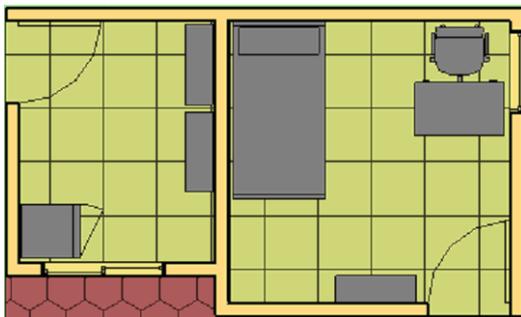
Planta arquitectónica de la enfermería y miscelánea.
